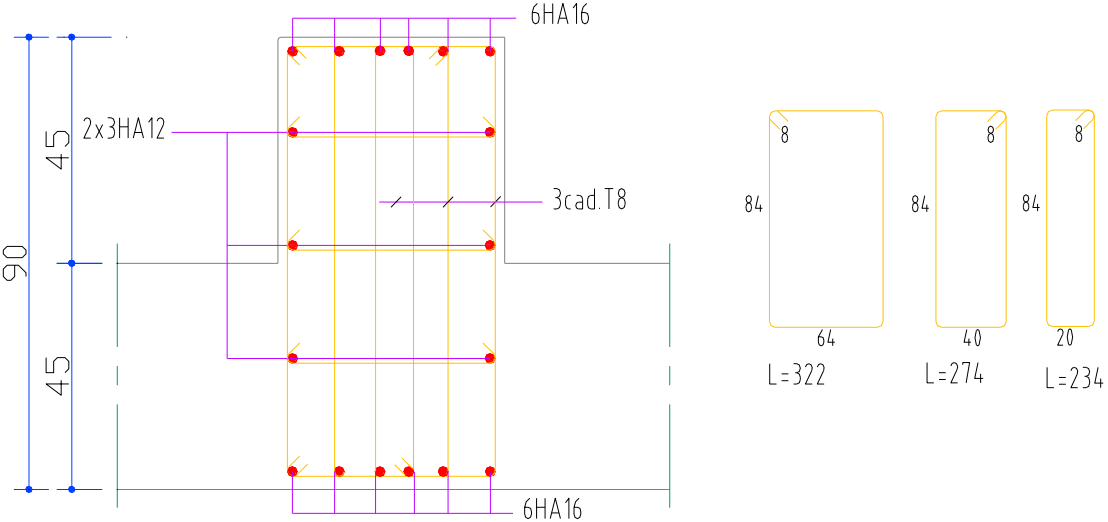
Coupe de ferrailage des nervures principales au niveau travée.
